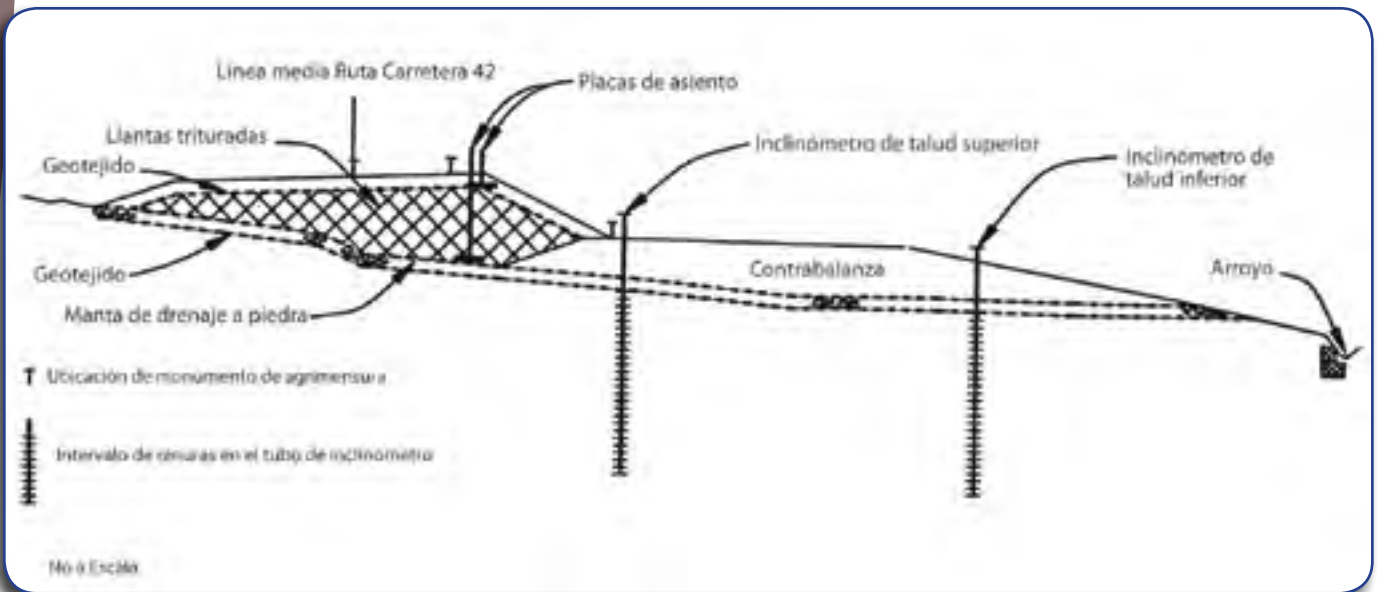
Corte transversal de la prueba de campo de llantas trituradas en Oregon (Ref. 47)
